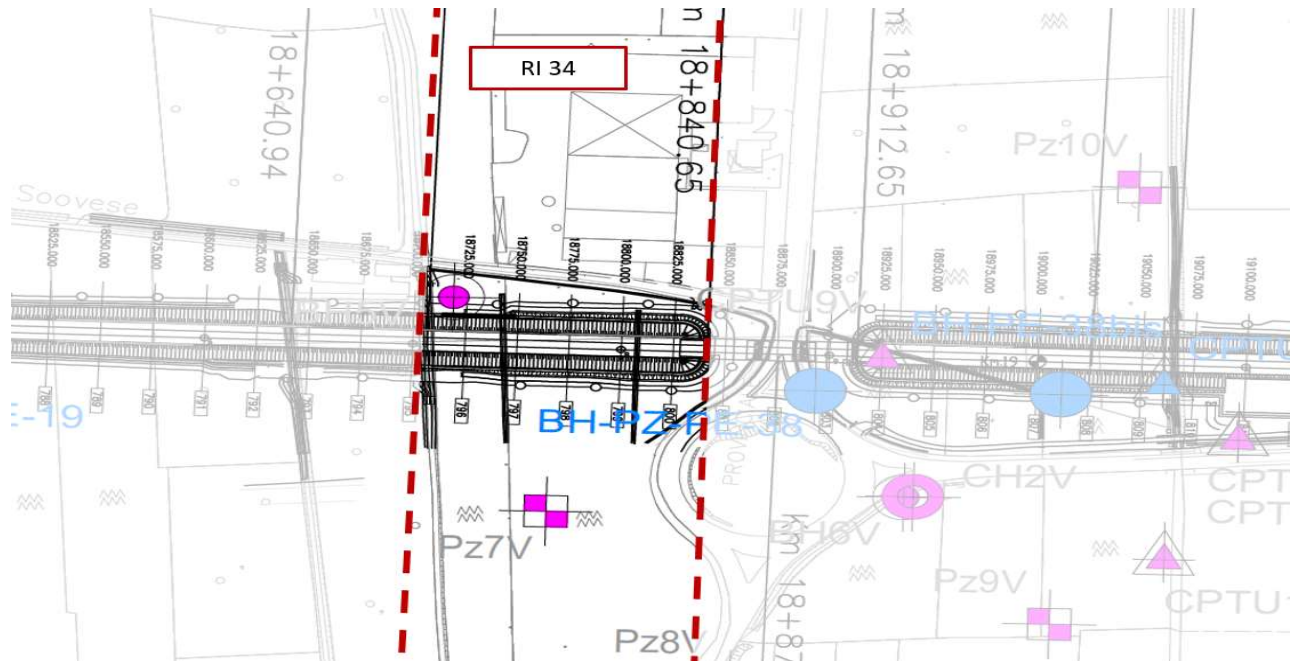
Planimetria Rilevato RI34, estratto dalla Planimetria Generale (Doc. Rif. [3])
